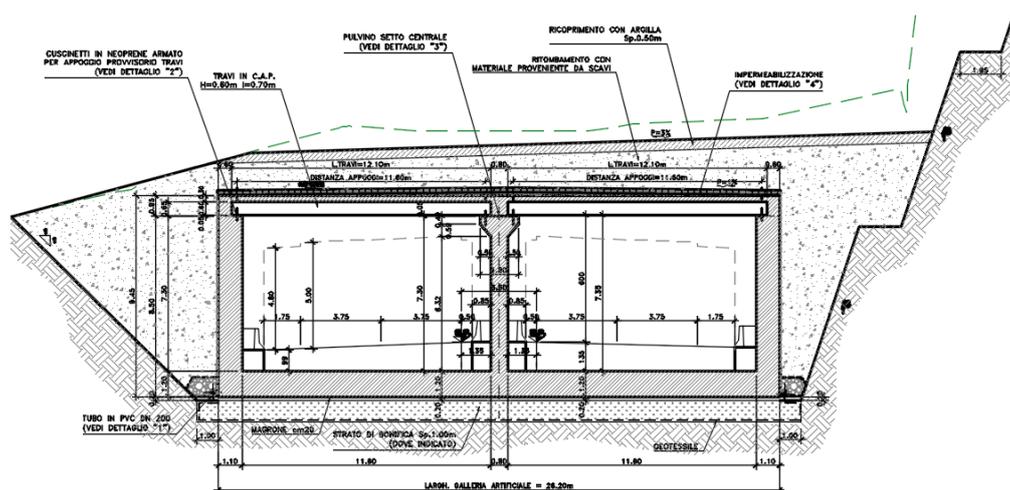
Sezione trasversale galleria artificiale doppia canna GA02
